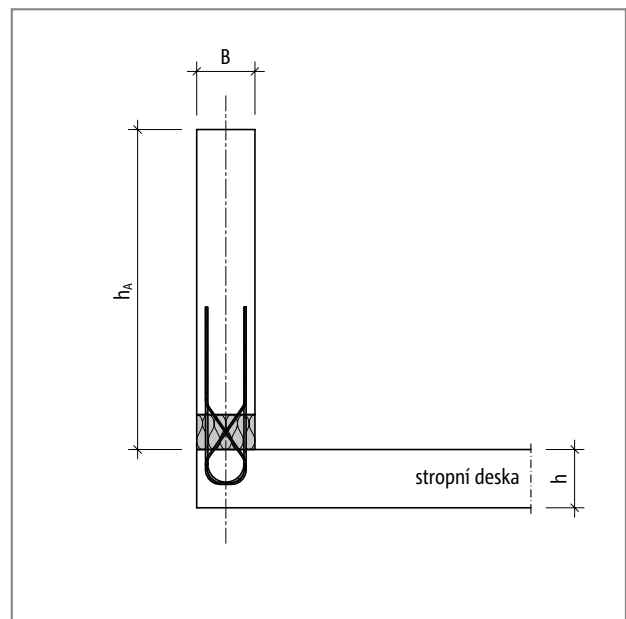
Schöck Isokorb® T typ AP: Znaménková konvence pro dimenzování parapetů uložených na stropní desce
